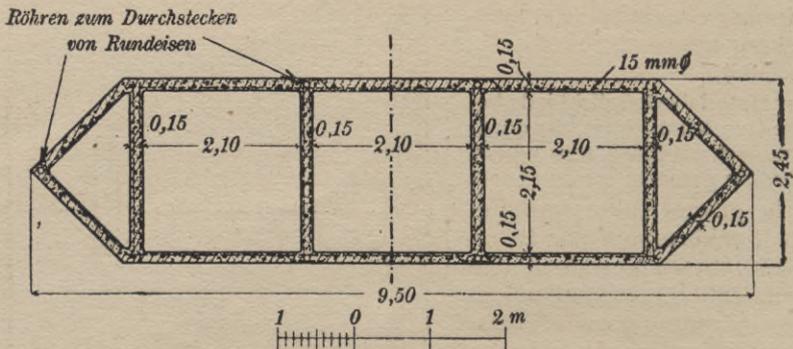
Eisenbeton-Senkbrunnen vom Grundriß des ganzen Pfeilers, aus mehreren Schüssen zusammengesetzt.¹⁾
